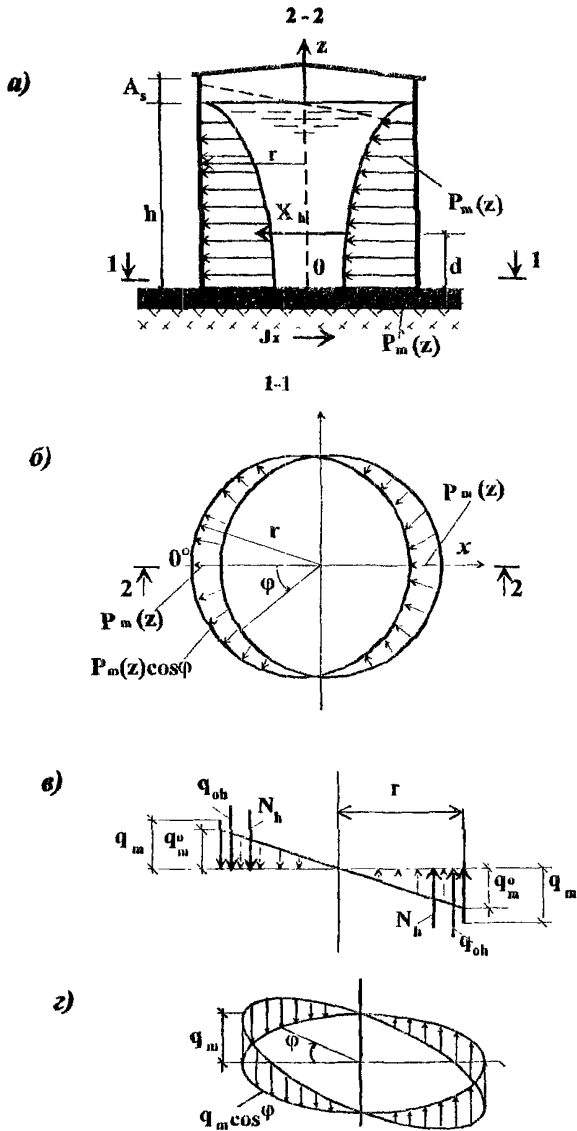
Схема к расчету фундаментной плиты на нагрузки от гидродинамического давления
